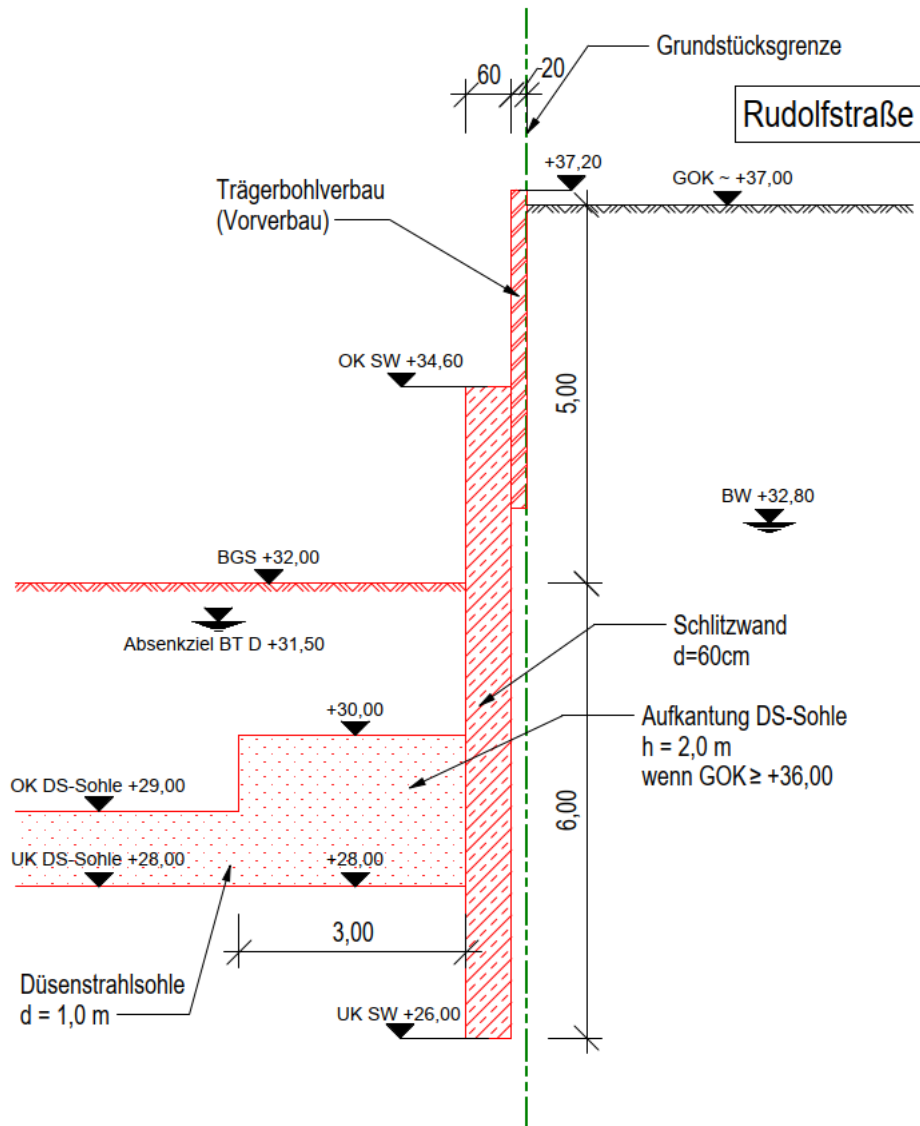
Baugrube Bauteil D – Schnitt 9 (aus [U 7])
